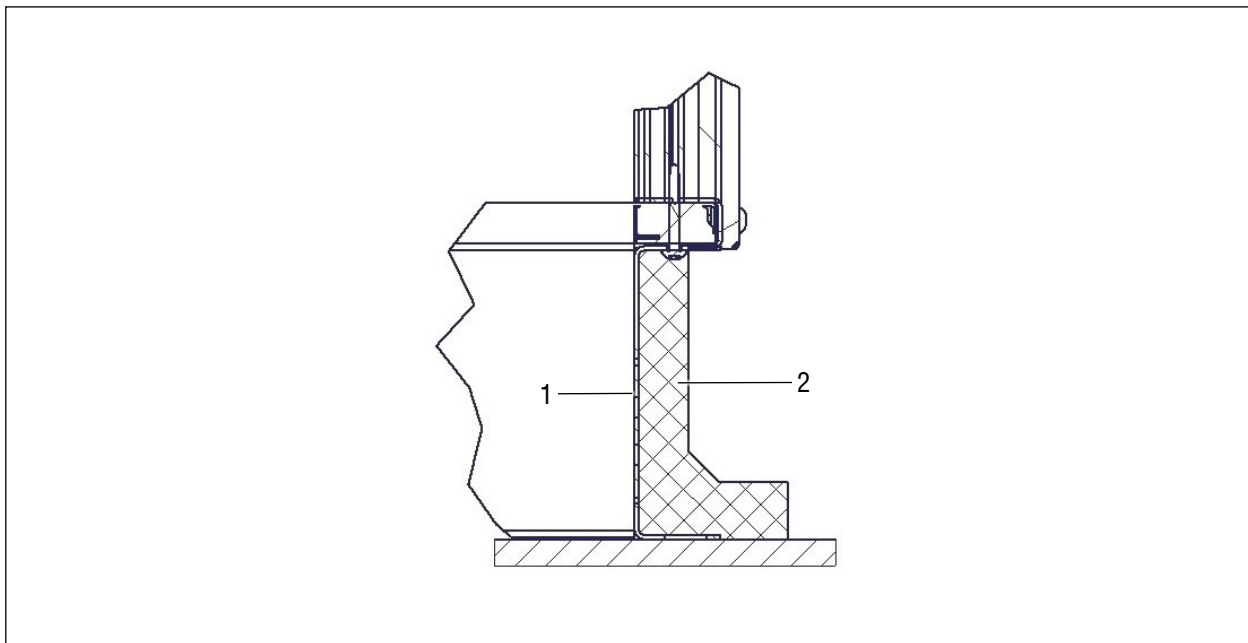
Rama dachu zamontowana wstępnie po stronie inwestora
